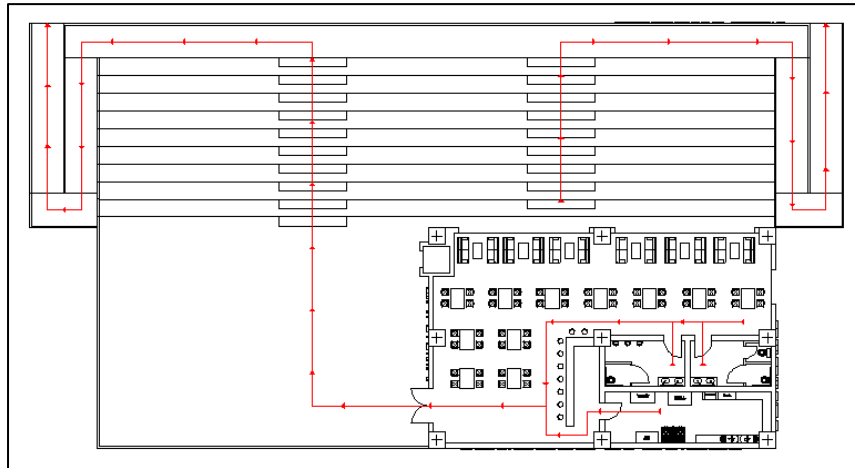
Esquema planta alta, detalle recorrido de evacuación en rojo.
